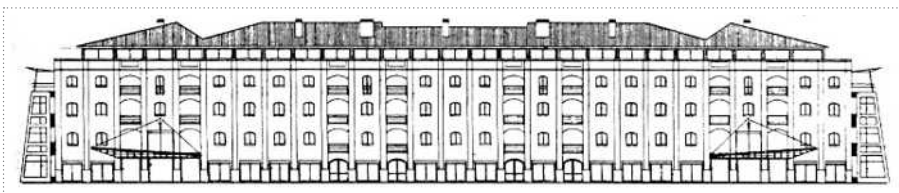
Fachada oeste Galpão 5. Fonte: Revista Arquis nº 1.
